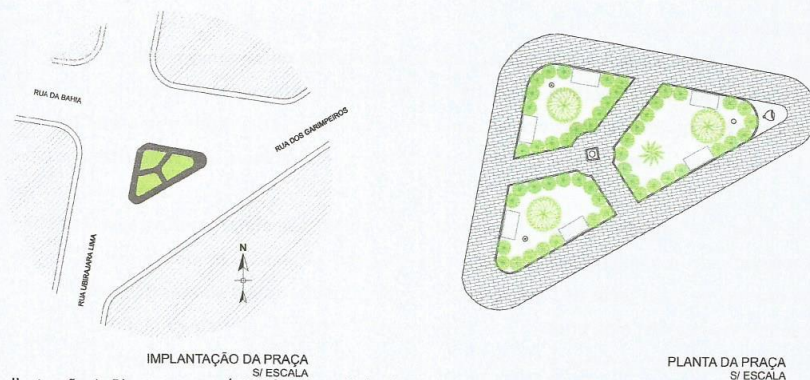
Planta esquemática da Praça 1º de Janeiro. Novembro/2010. Elaboração: Adriana Ferreira
